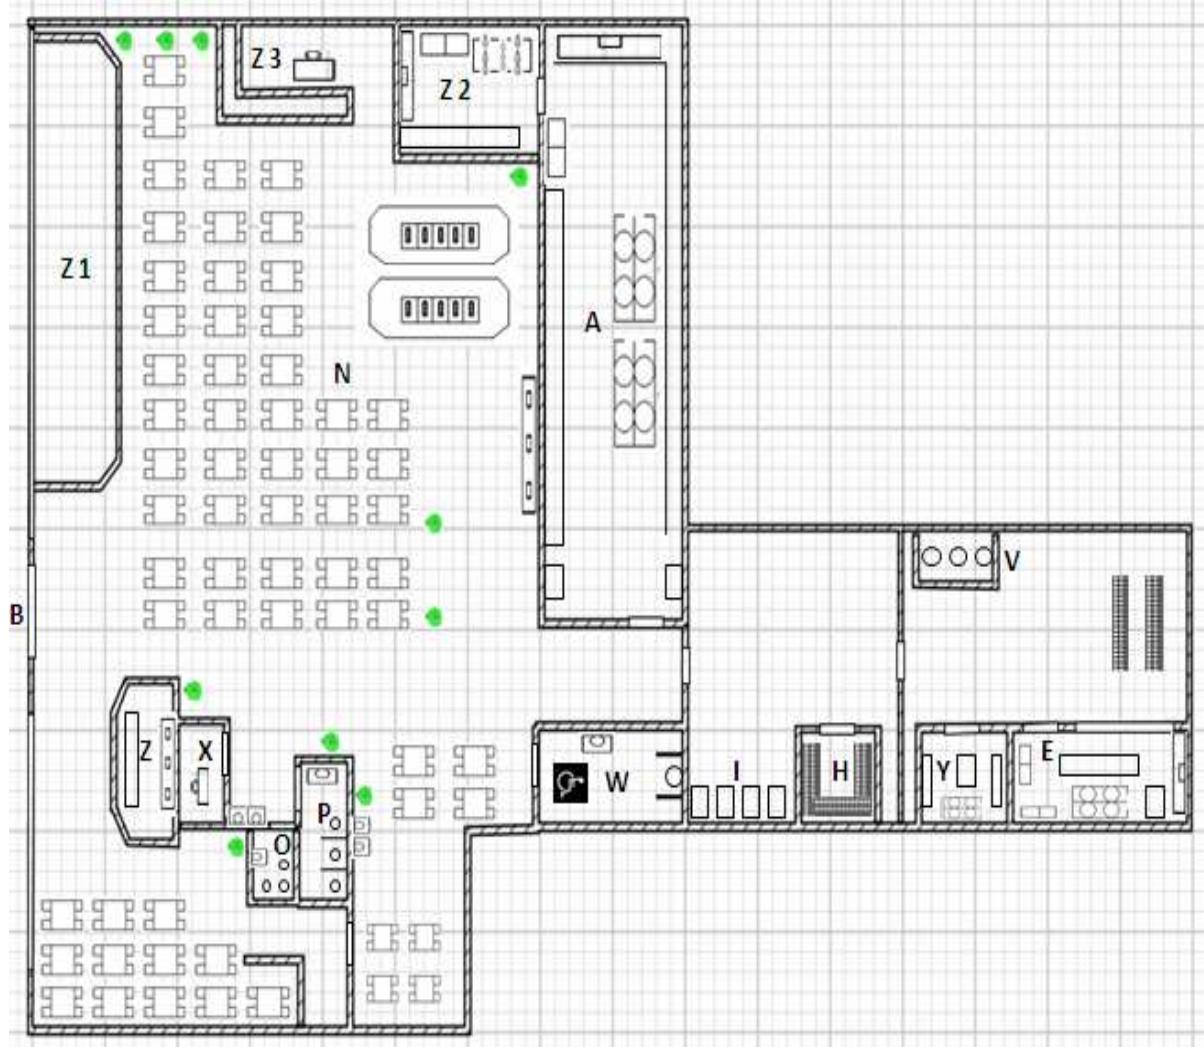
Planta Baixa do Restaurante Comercial (UAN 1)
